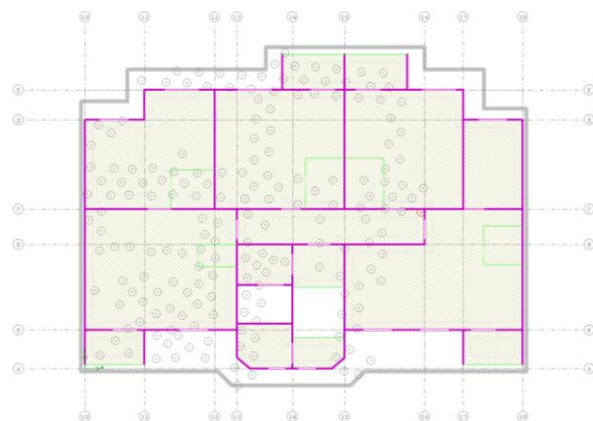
План фундамента центральной части здания (ранее забитые сваи)
